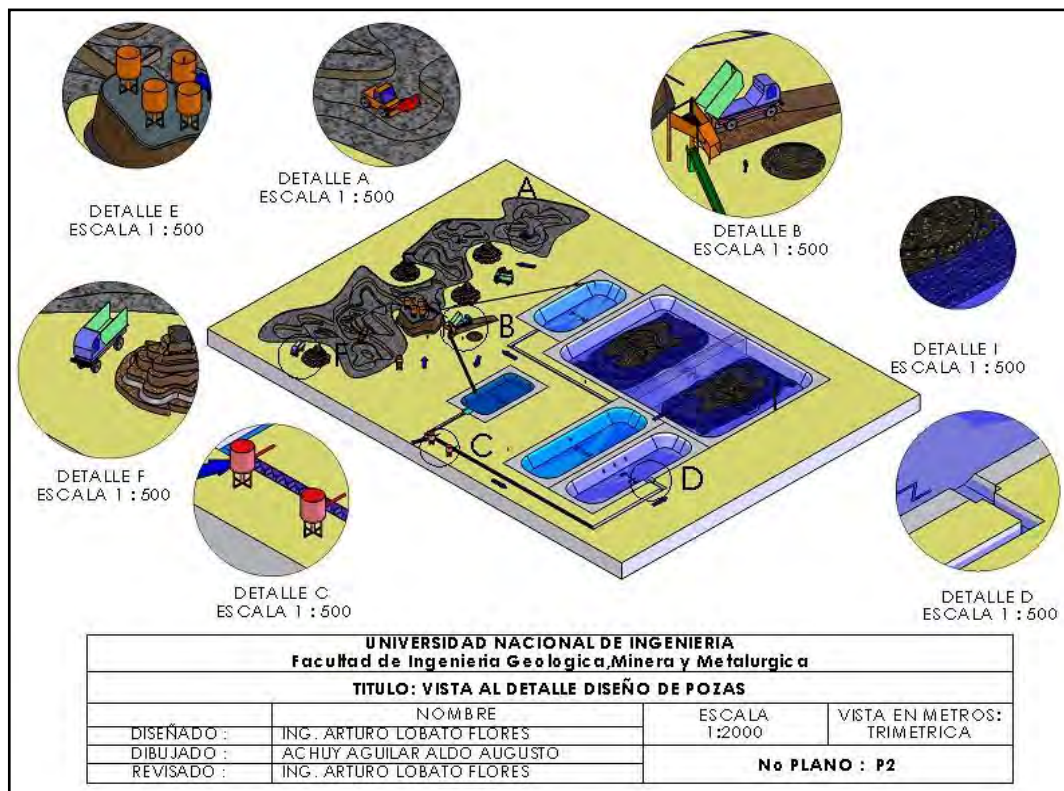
Vistas estratégicas de la planta de tratamiento de circuito cerrado, Alternativa N°1 - Elaboración propia.
